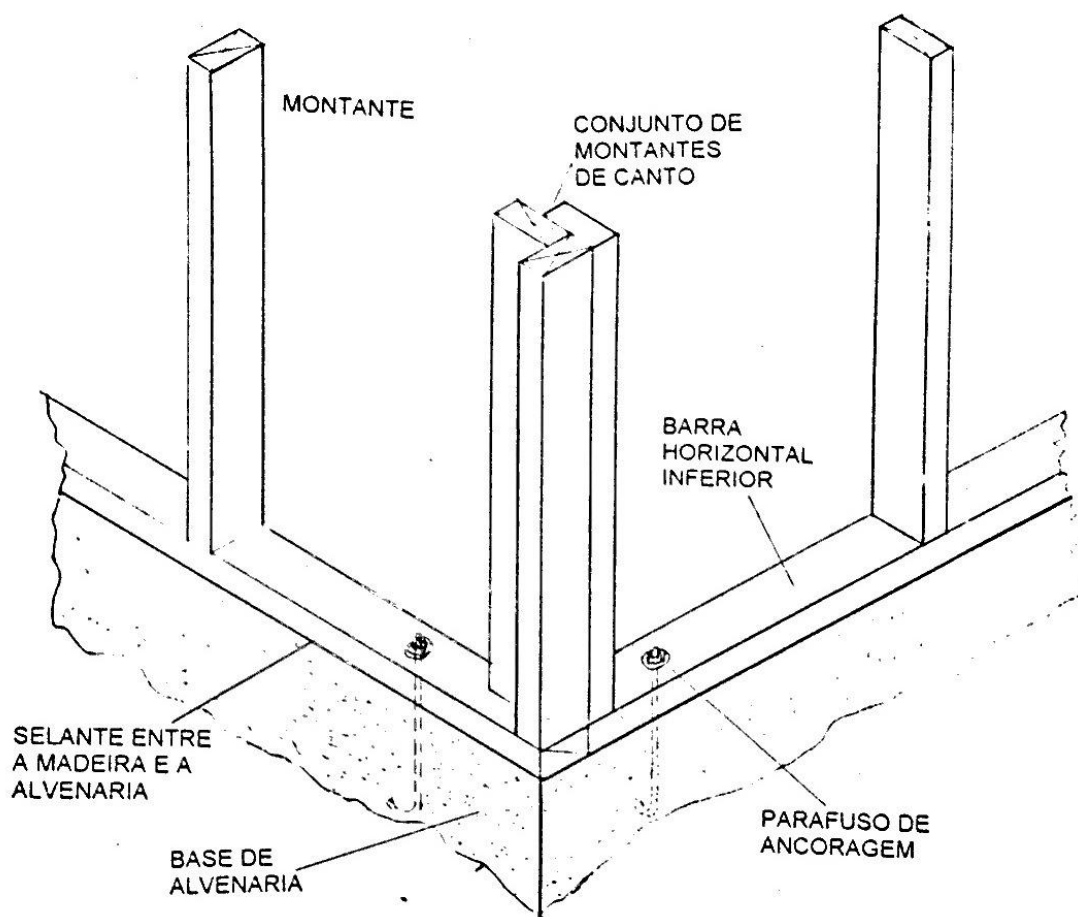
Detalhe da ligação da estrutura de madeira com a base de alvenaria
